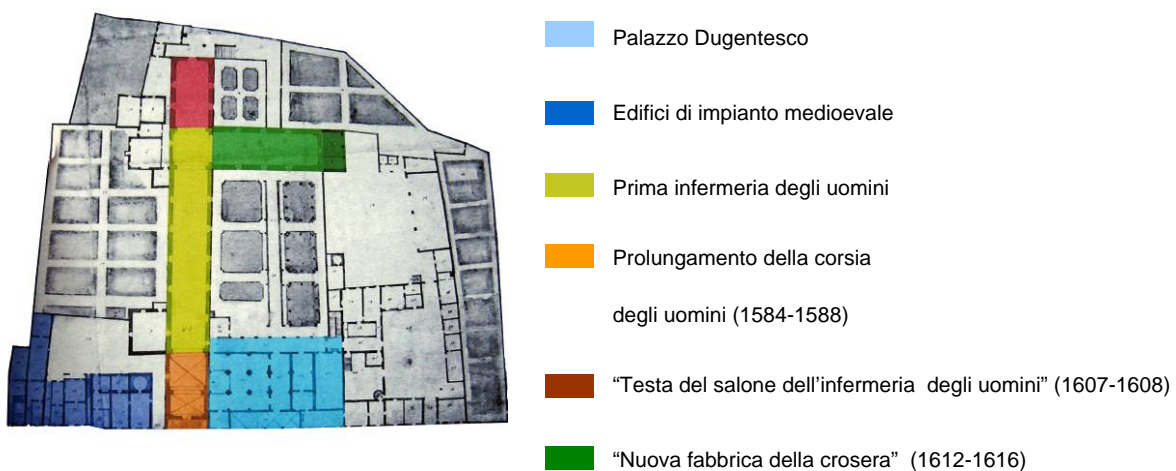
Ricostruzione delle fasi costruttive dell'impianto a crociera su pianta risalente alla prima metà del XVIII secolo
